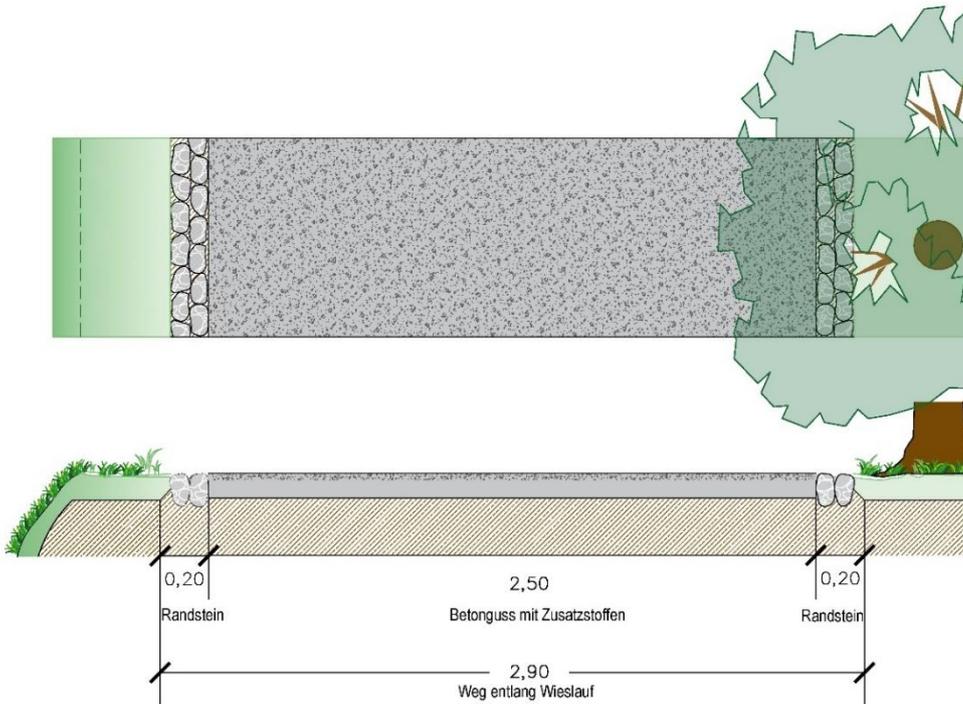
Beispielschnitt/ -draufsicht Wieslaufweg, Abschnitt Höhe Bushaltestelle bis Parkanlage mit Ortbetondecke
